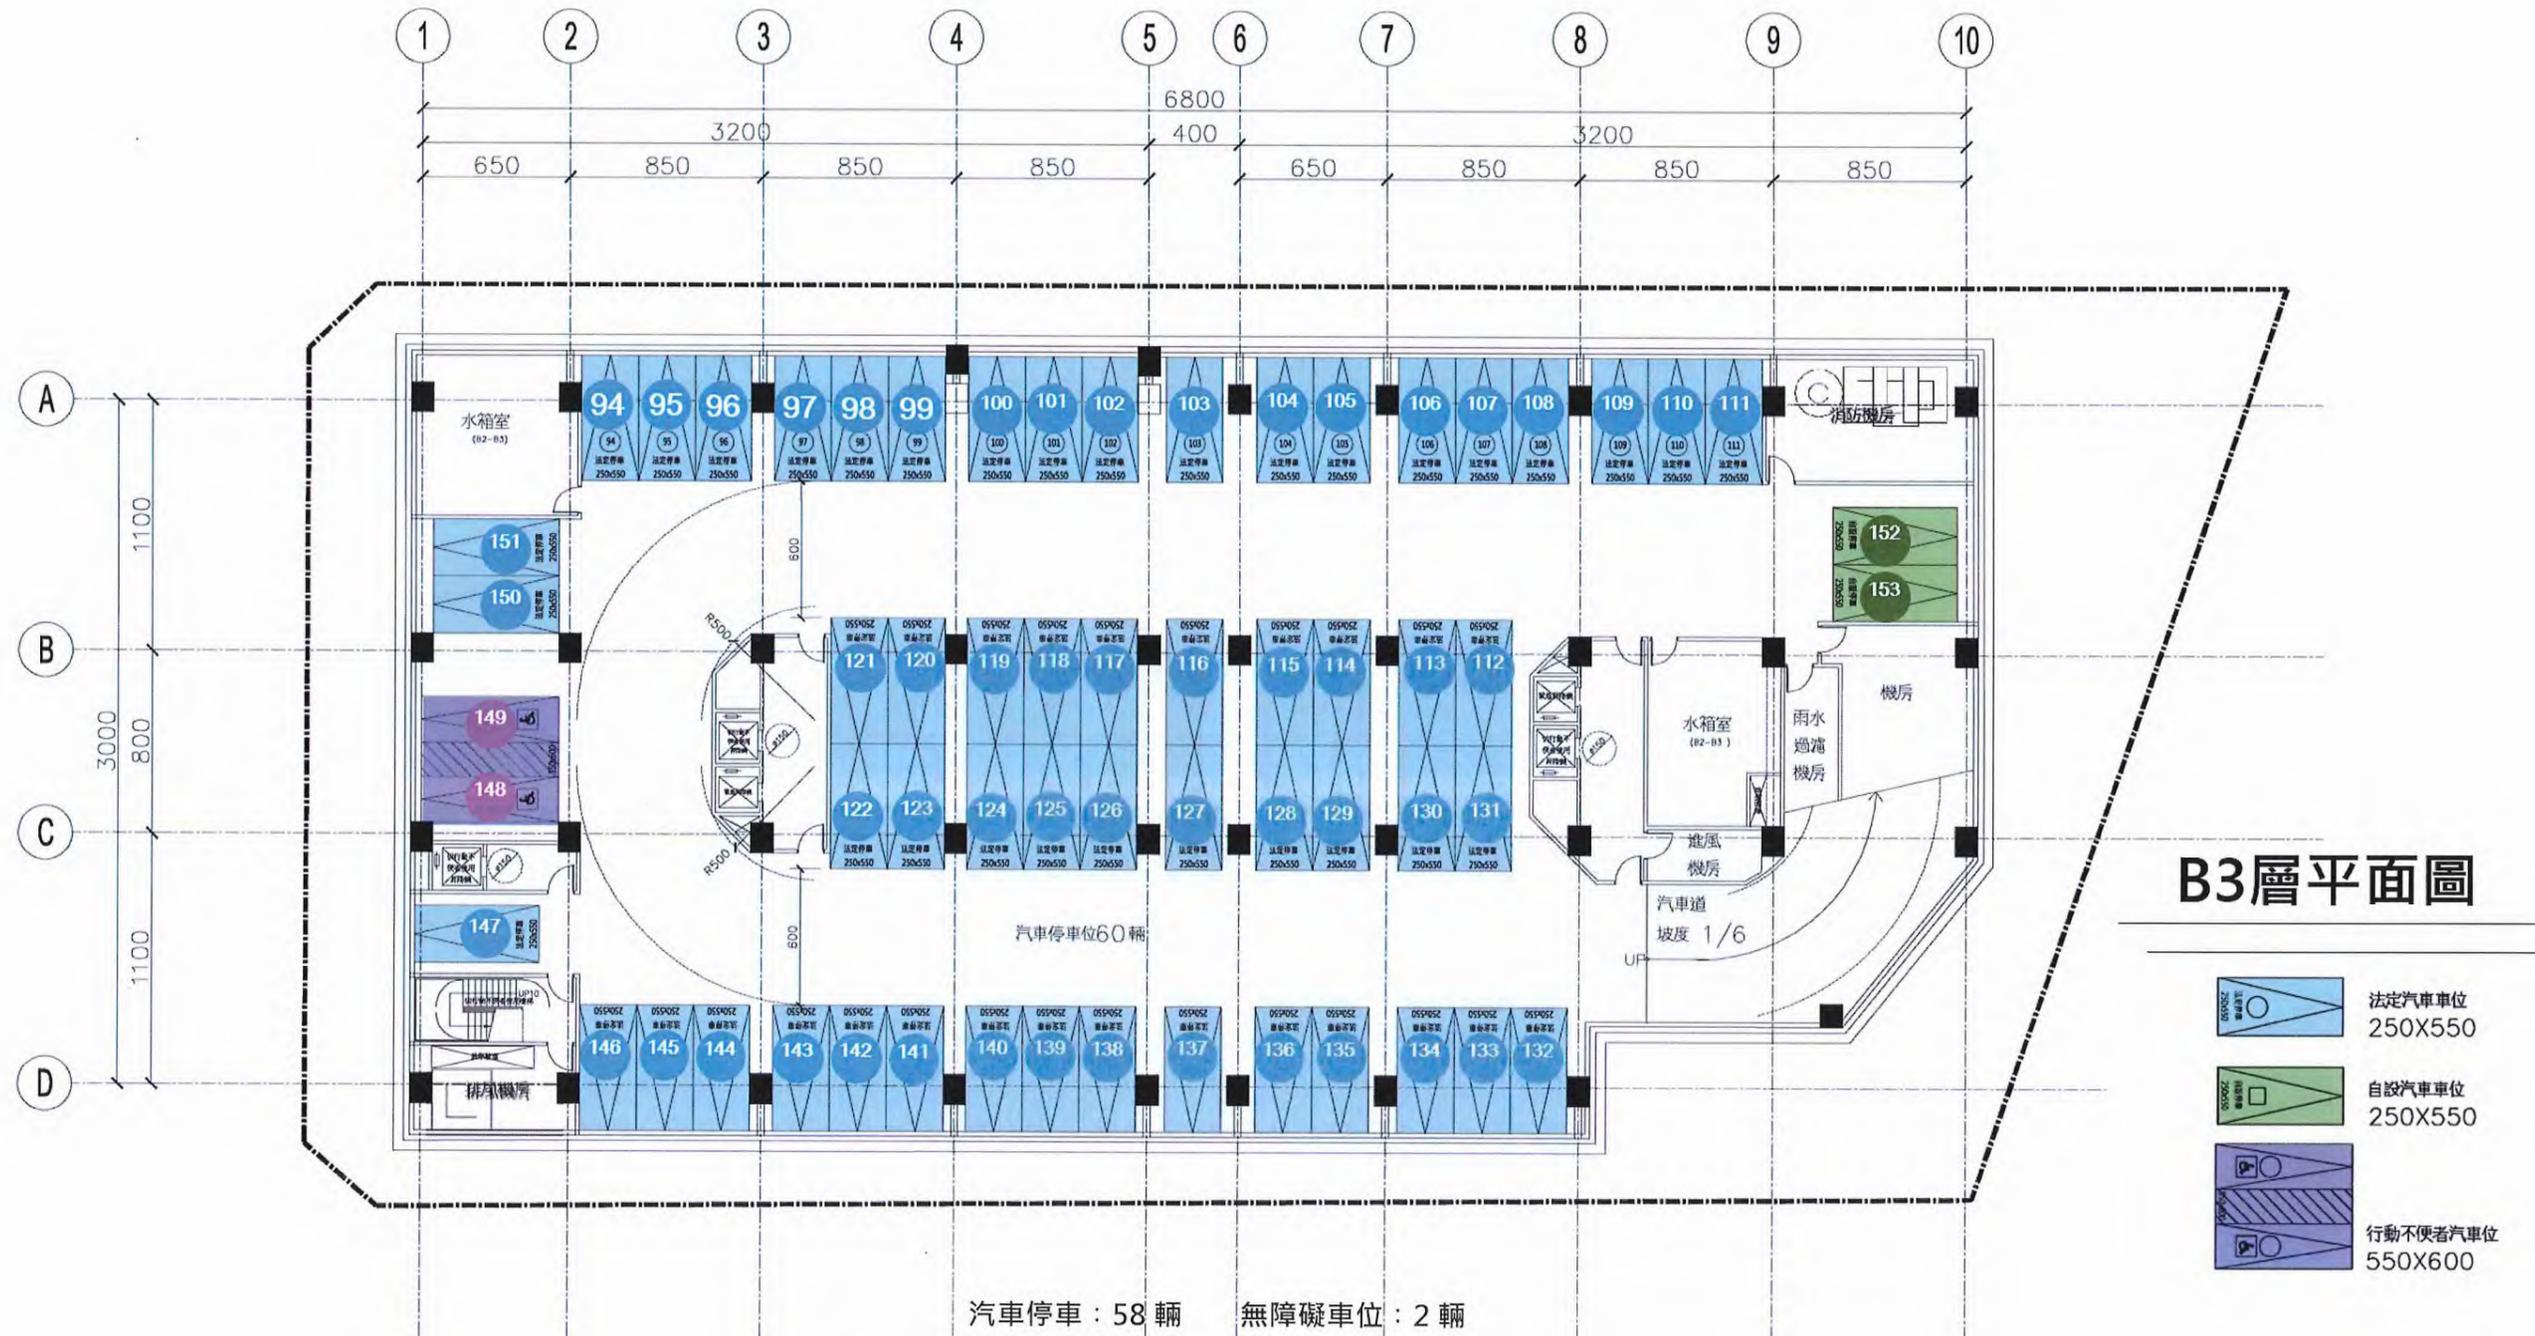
地下三層平面暨面積計算圖(S:1/300)
